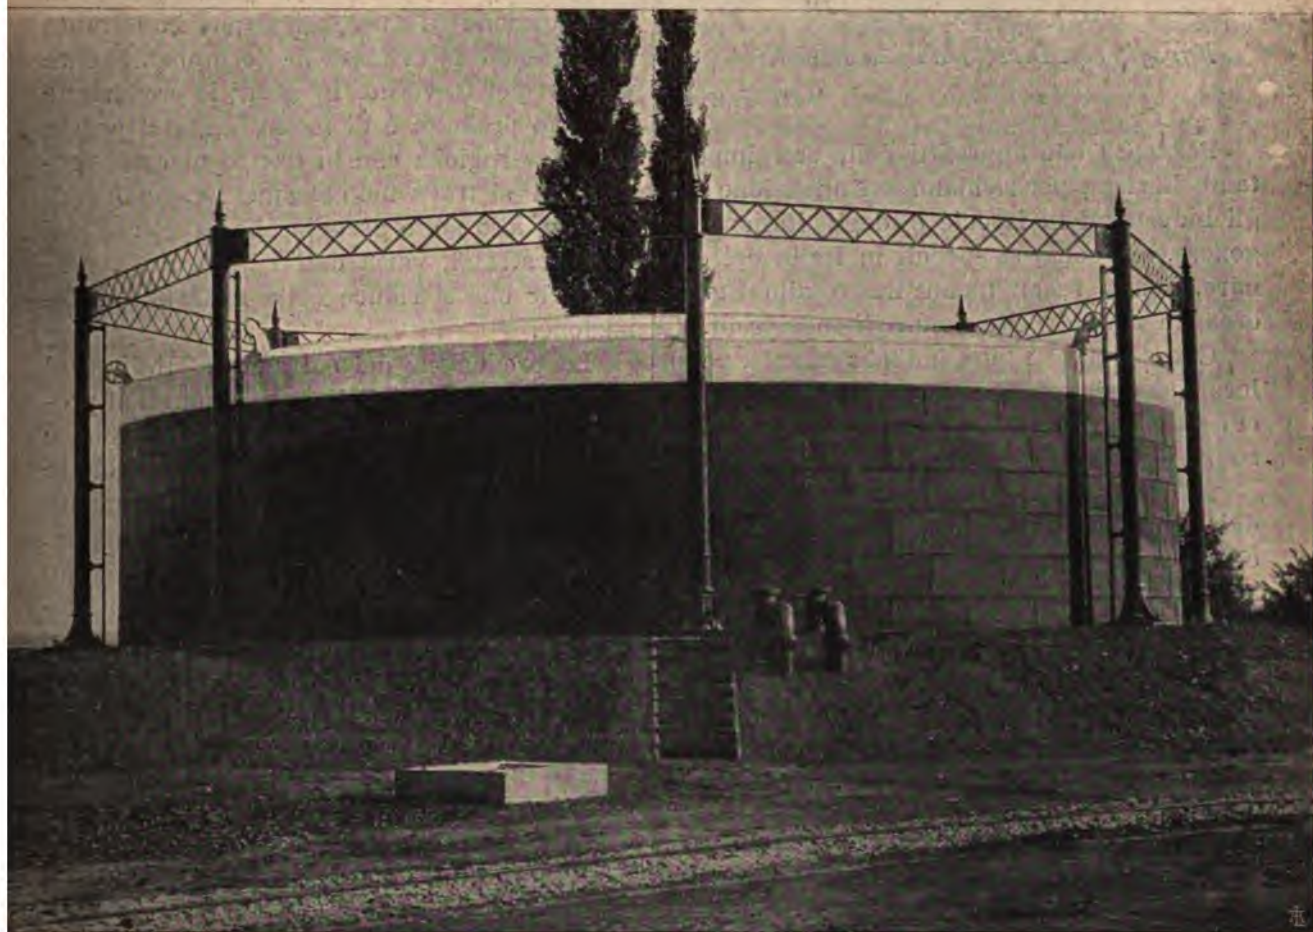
Il gazometro costruito dalla Ditta Ing. Bolletta e Polatti
